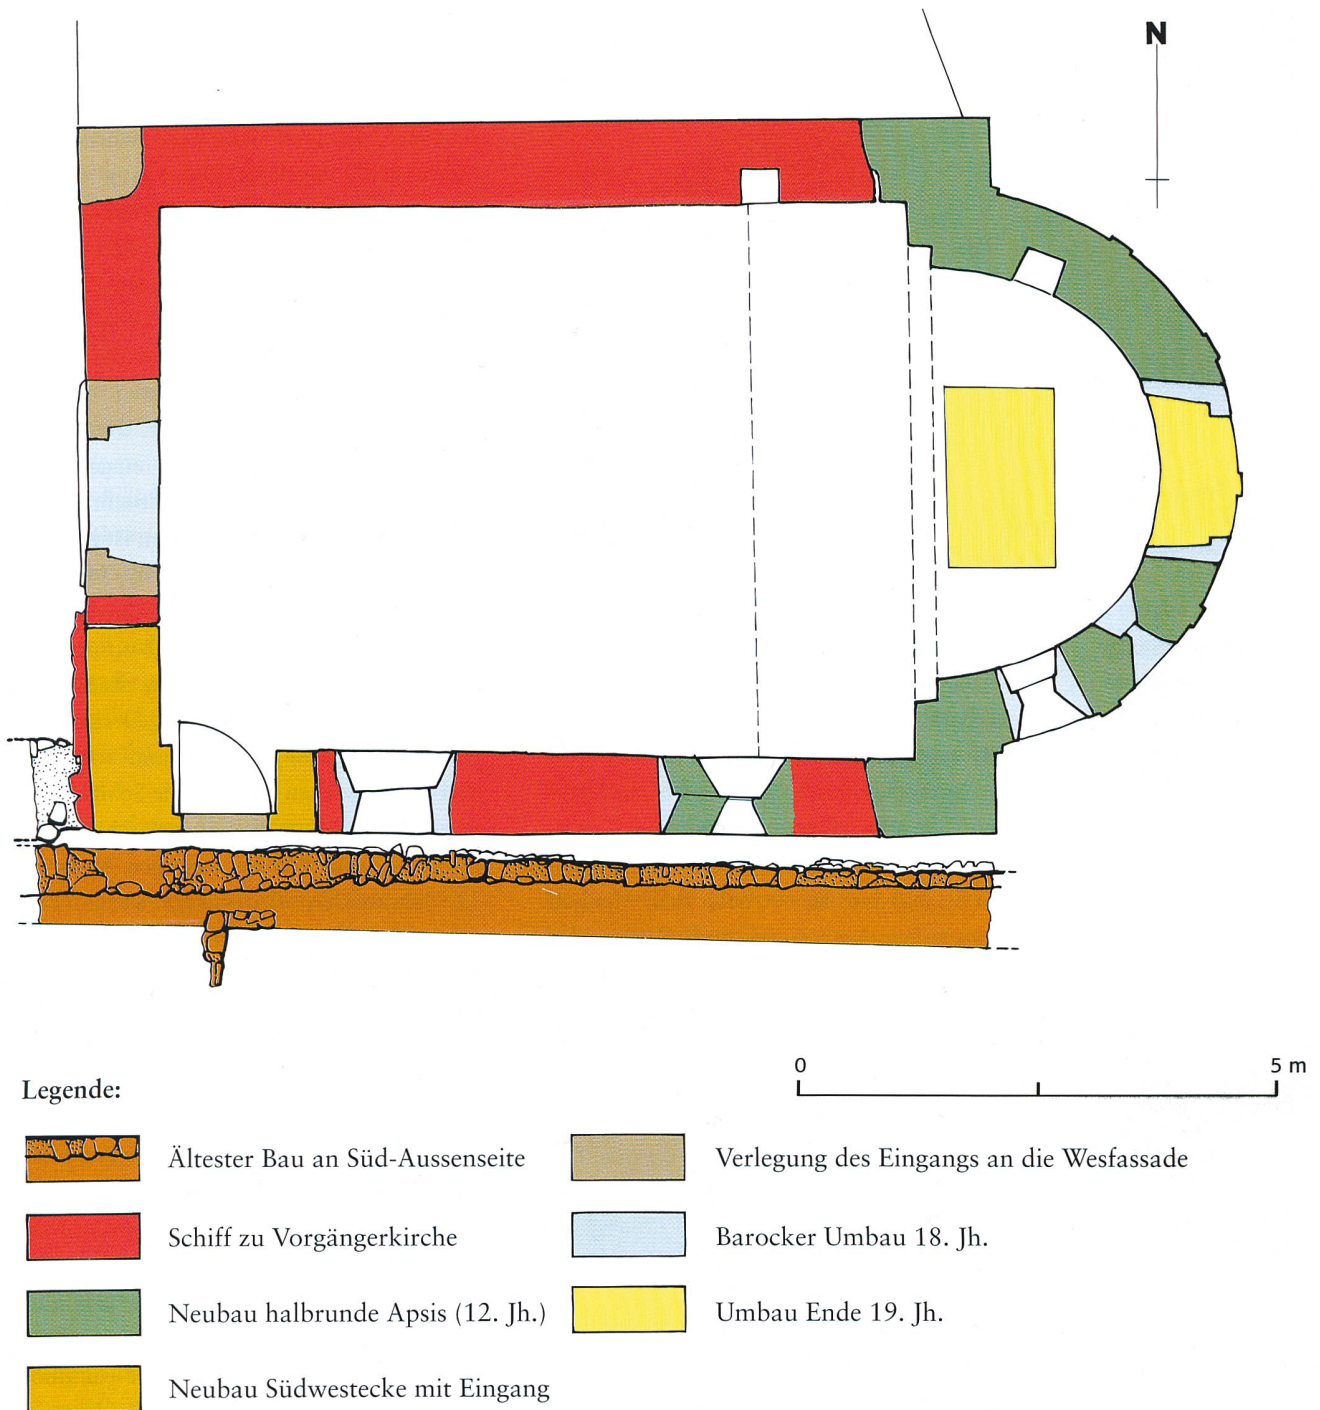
Cazis, Kapelle St. Wendelin. Grundriss mit den verschiedenen Bauphasen der Kapelle.
